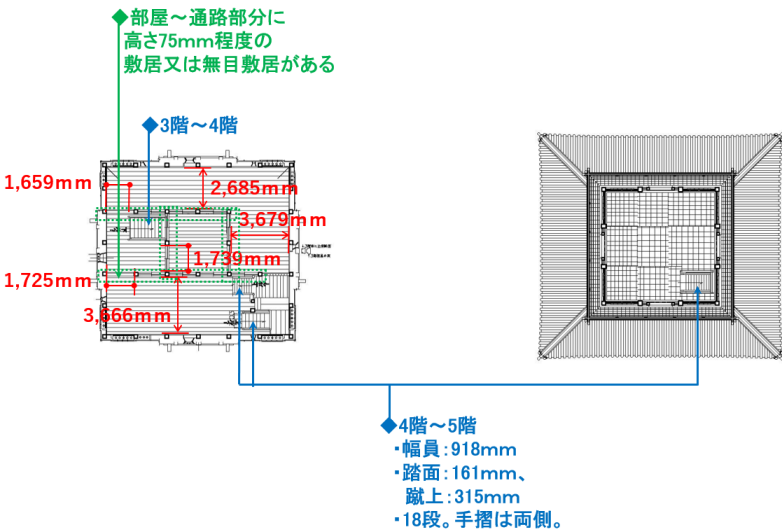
天守 4 階平面図及び天守 5 階平面図（復元原案）
